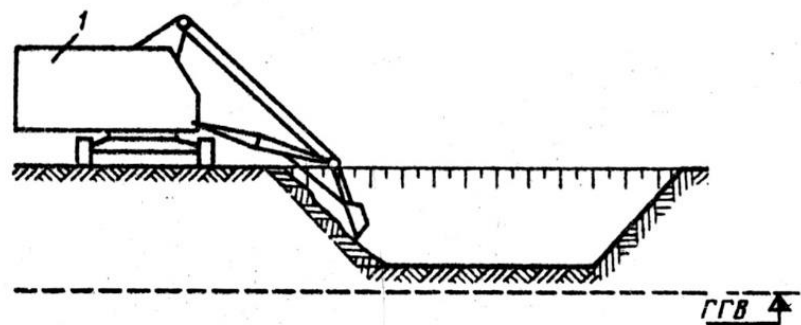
Розробка котловану з укосами екскаватором зворотна лопата
